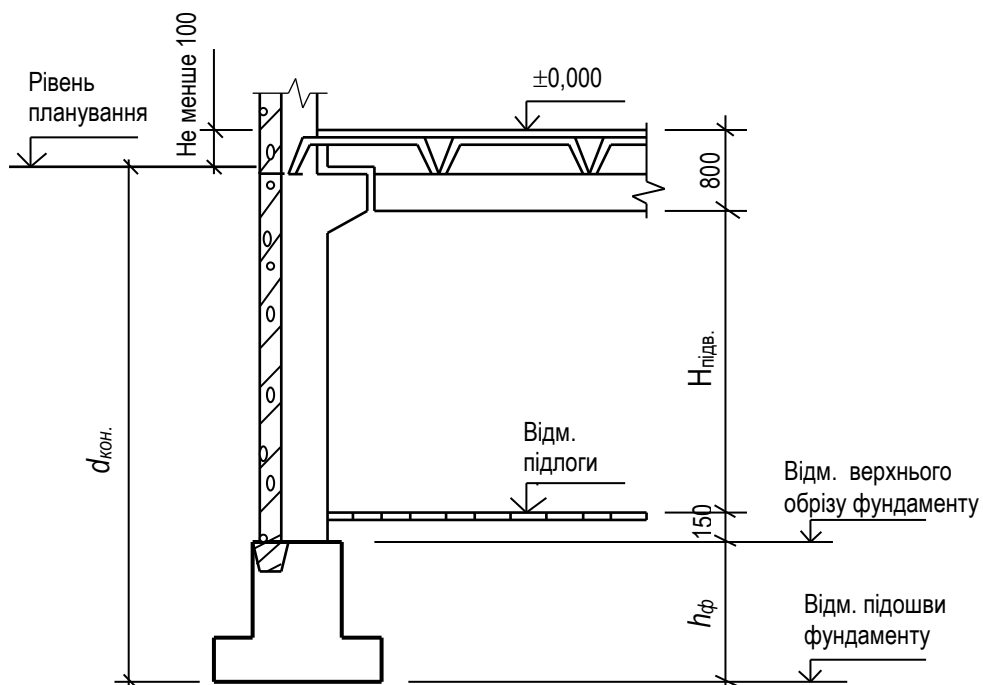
Попереднє конструювання окремого (стовпчастого), монолітного фундаменту під збірну залізобетонну колону. Варіант з підвалом
